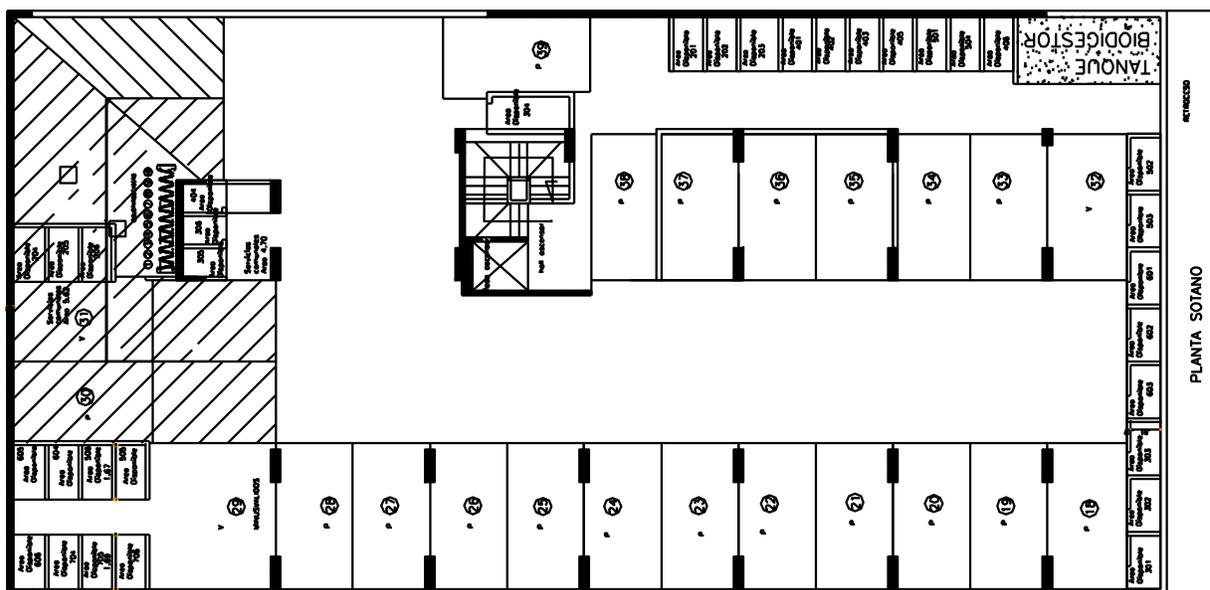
, Planta sótano, edificio avanti, proyecto personal, 2008.
